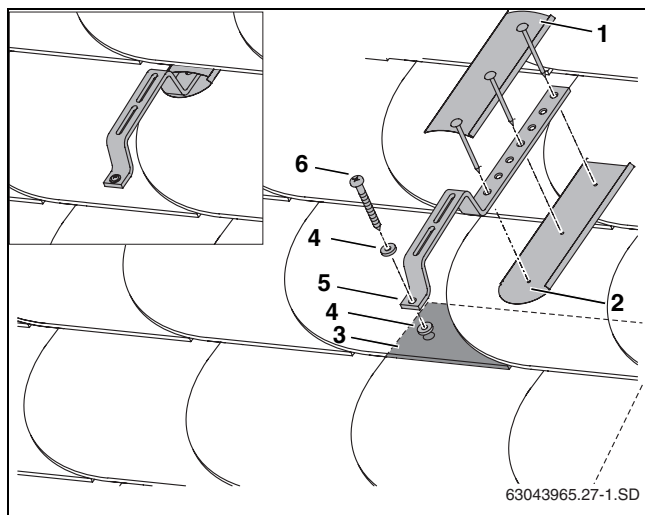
Монтаж на крыше с покрытием шифером/гонтом
